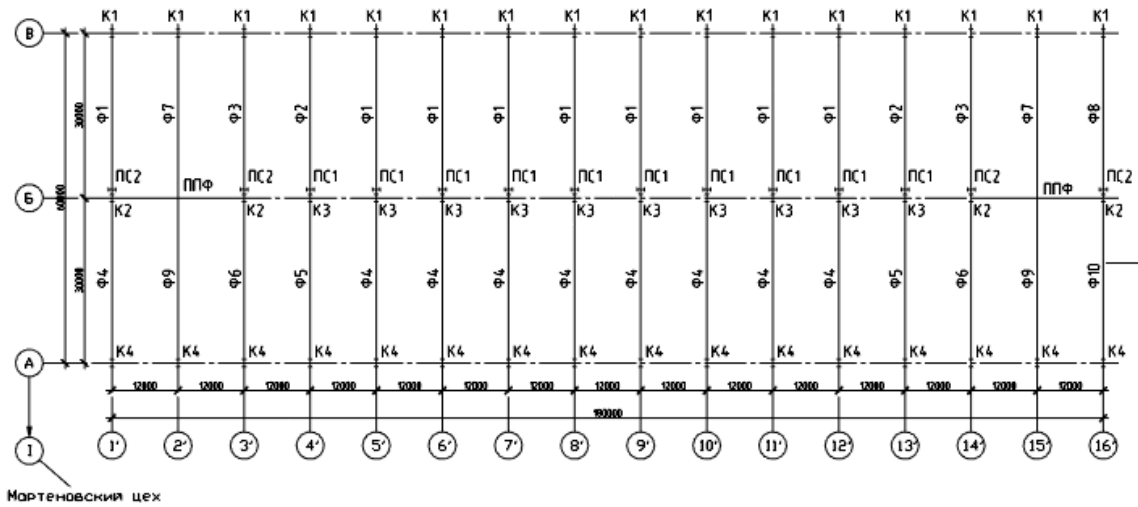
План колонн, подкрановых стоек, стропильных и подкраново-подстропильных ферм здания ОНЛЗ
